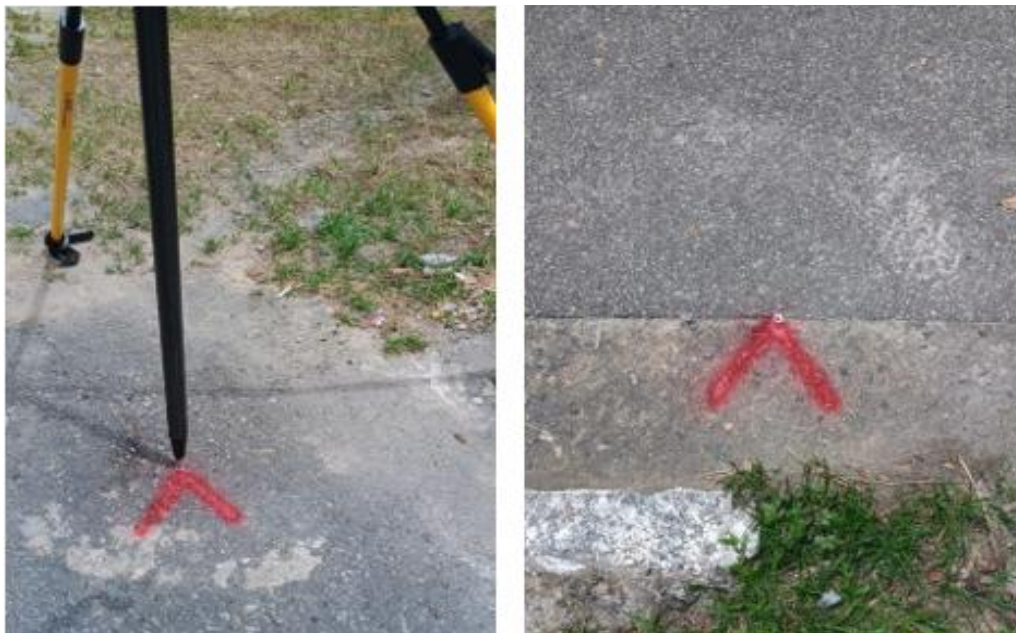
Levantamento GNSS – Levantamento geodésico dos pontos P3 e P4
